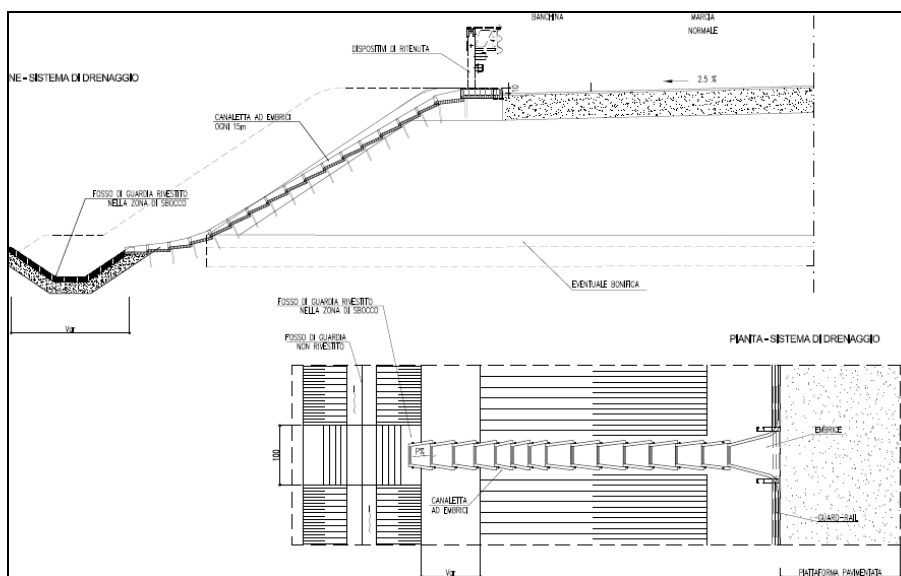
PARTICOLARE CANALETTE AD EMBRICE
